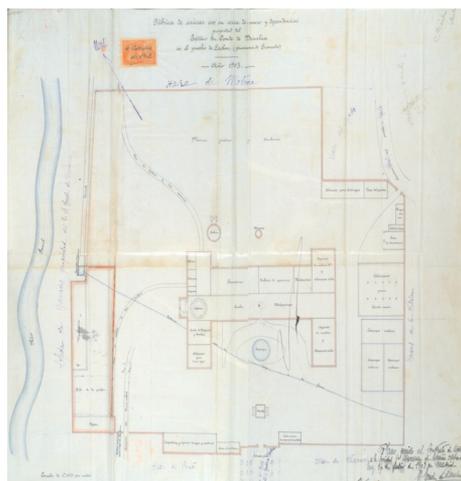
Plano general de la Azucarera Conde de Benalúa del año 1903. Firmado por el Conde de Benalúa
